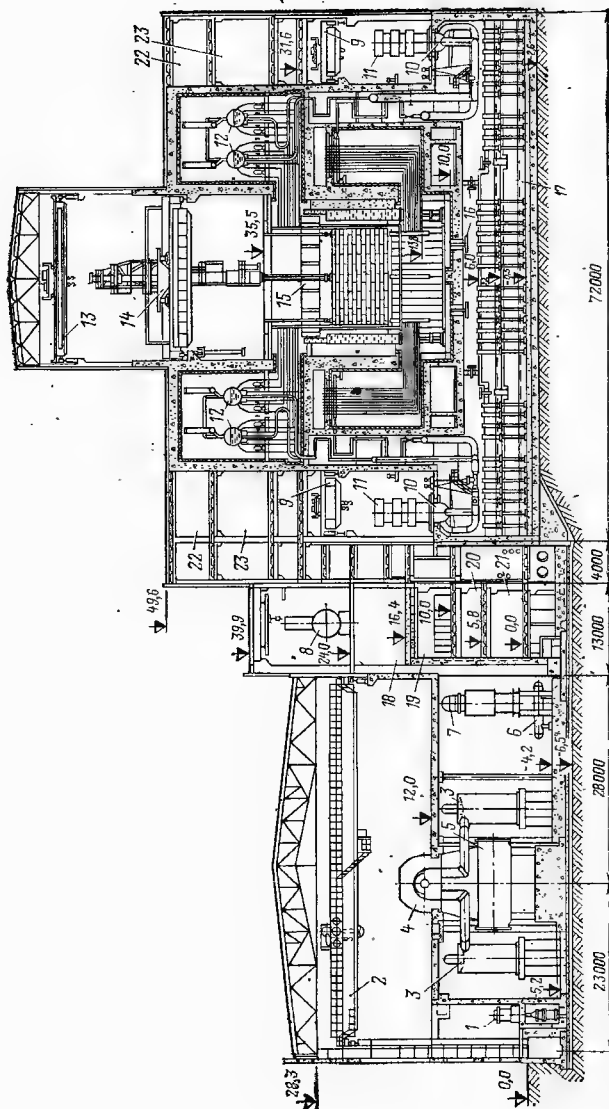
Главный корпус одноконтурной АЭС с реактором РБМК-1000 (поперечный разрез):
